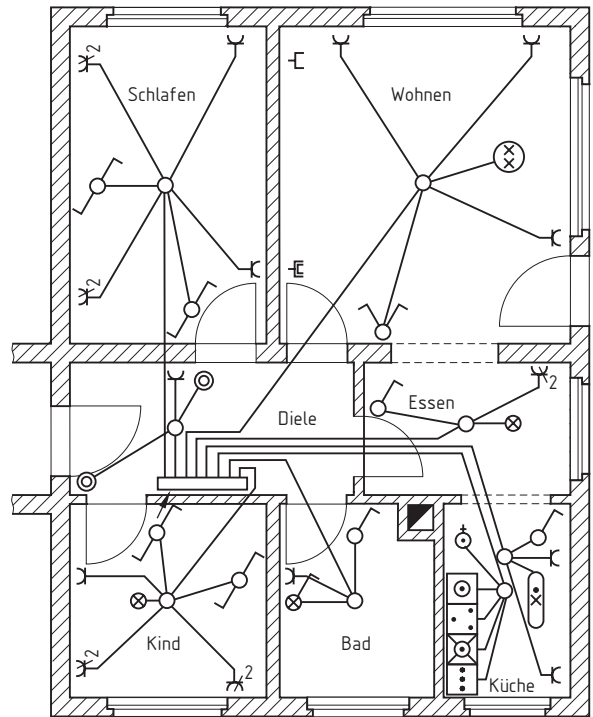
Installationsschaltplan einer Vierzimmerwohnung. Leitungsführung über Deckendosen
